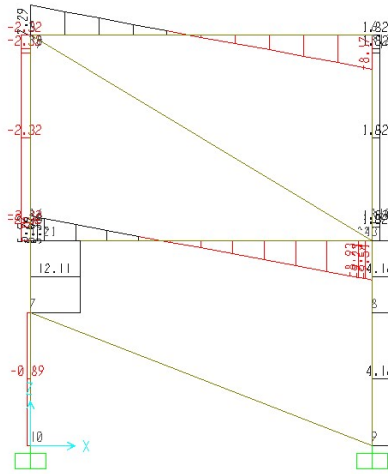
Mecanismo de falla en pórtico de hormigón armado parcialmente relleno con mampostería del modelo 2Cc-C.
